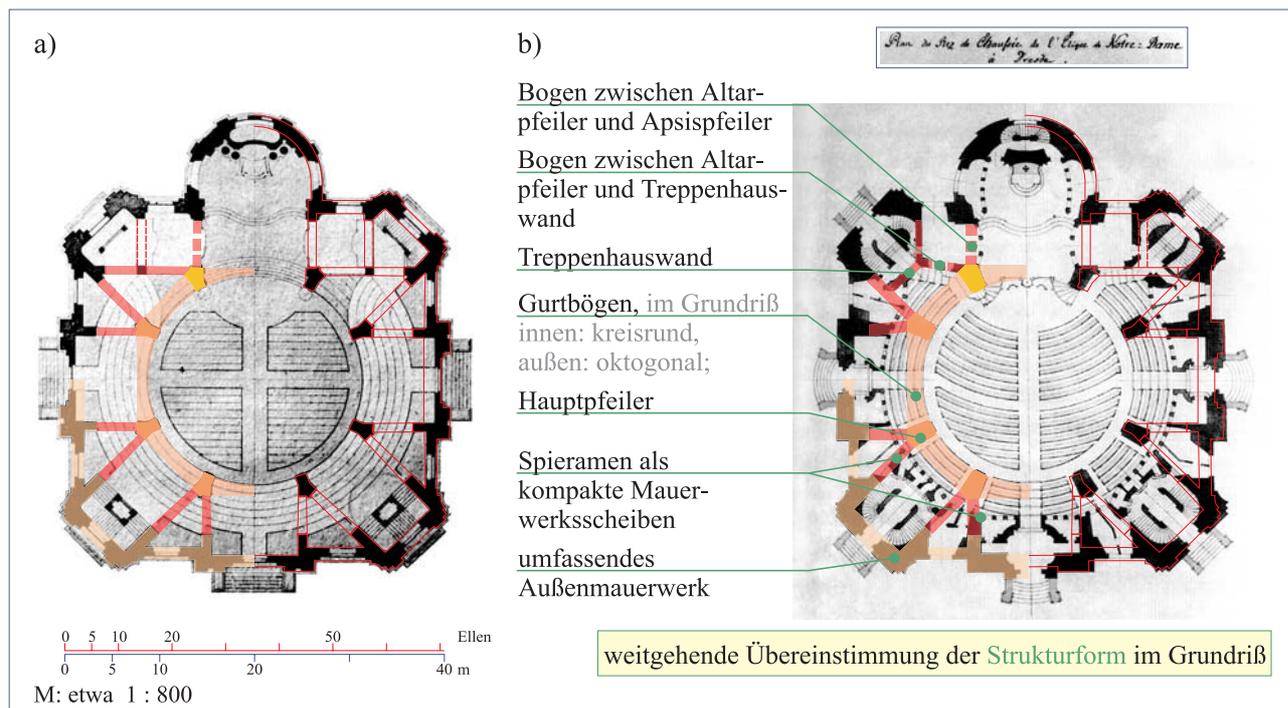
Weiterentwicklung des Grundrisses der dresdner Frauenkirche (Grundriß Erdgeschoß).
